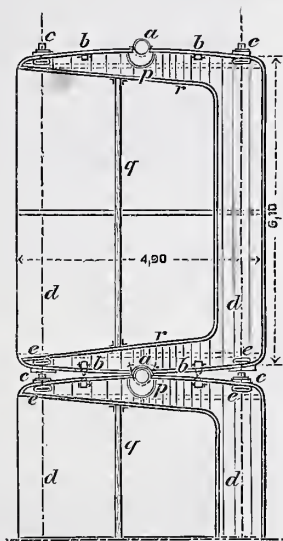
Grundriss der Schiffsgefäße.
